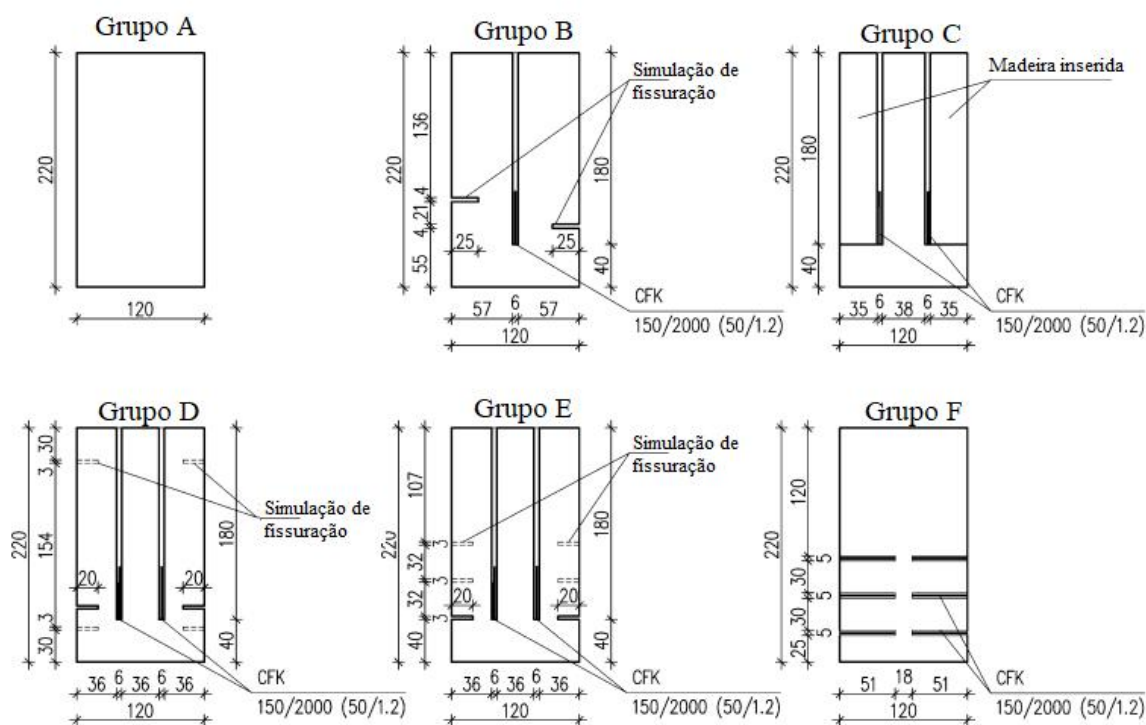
Secção transversal das vigas com indicação de cada grupo e posições dos reforços (Jankowski et al, 2010).
